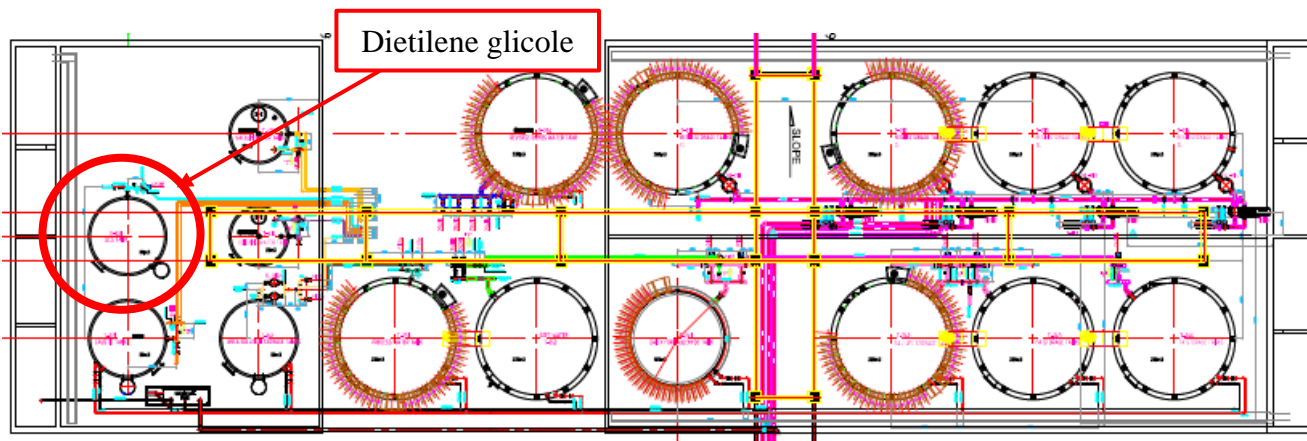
Stralcio planimetria parco serbatoi con ubicazione del serbatoio di dietilene glicole
